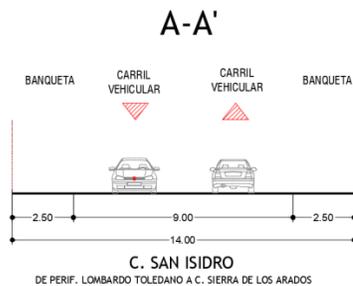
Vista de la C. San Isidro y su sección vial de acuerdo con el PDU 2040.
